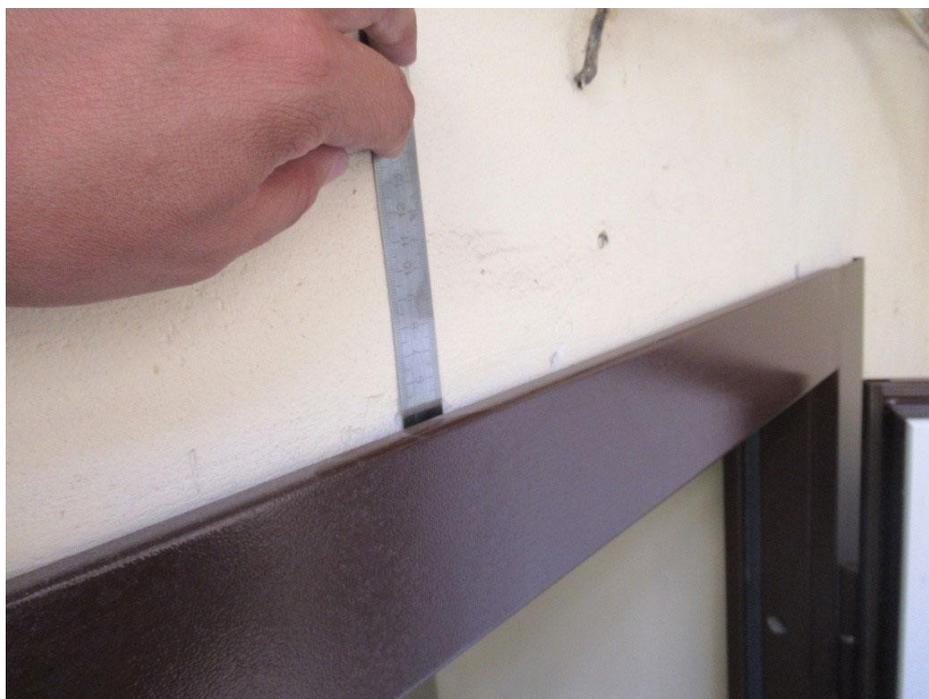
Монтажные зазоры между наружной стеной и дверным блоком (верхняя часть) не заполнены. Монтажные швы не выполнены. (общий план)
